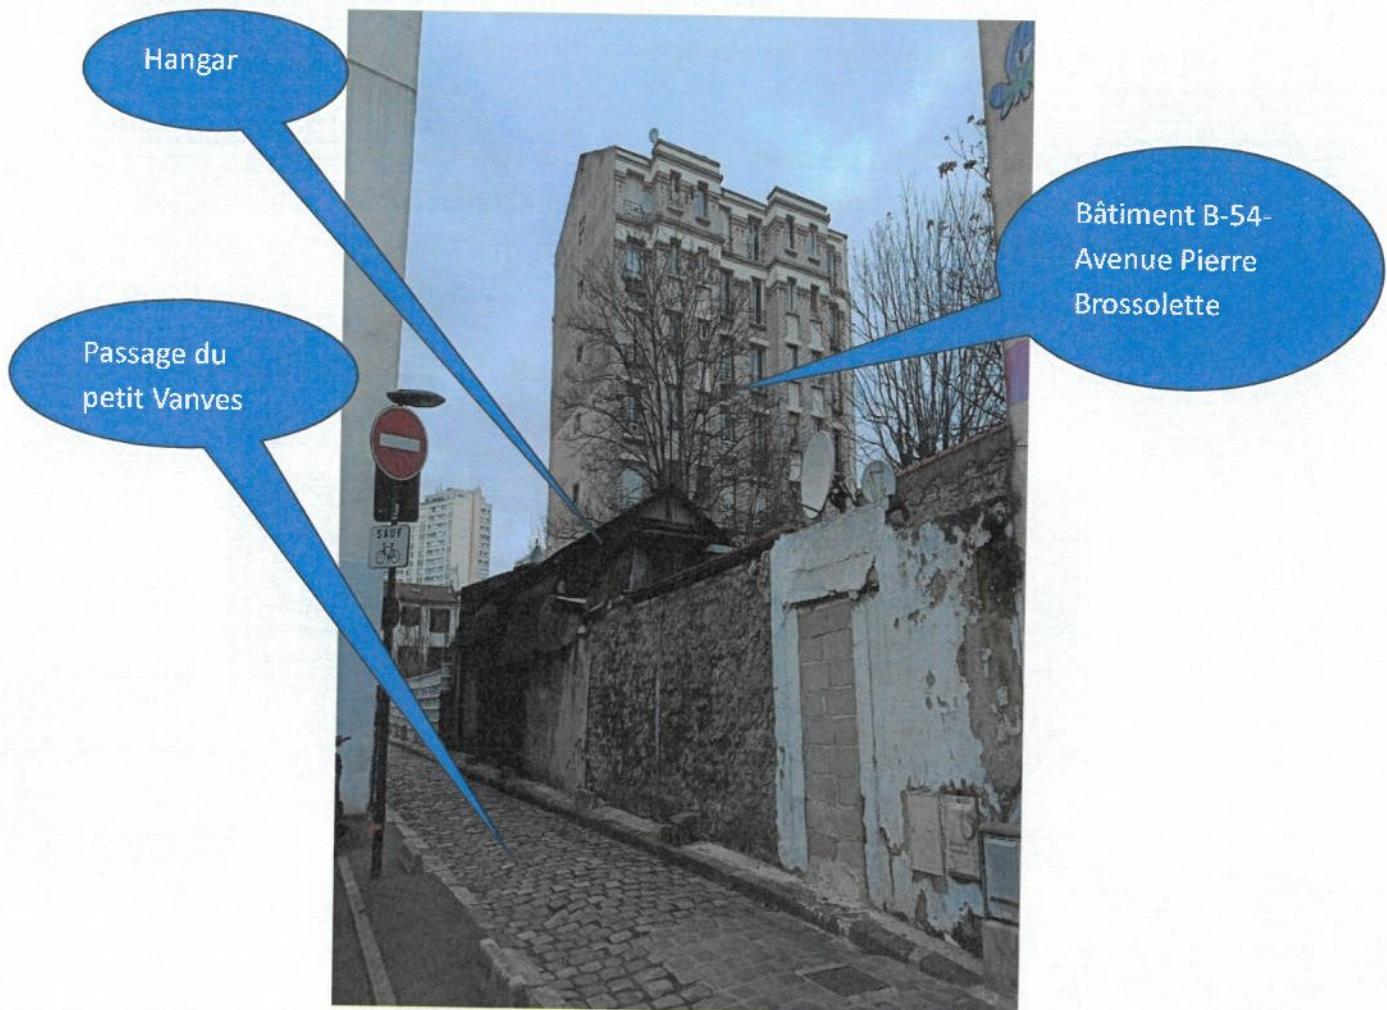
Bâtiment B - 54 Avenue Pierre Brossolette
